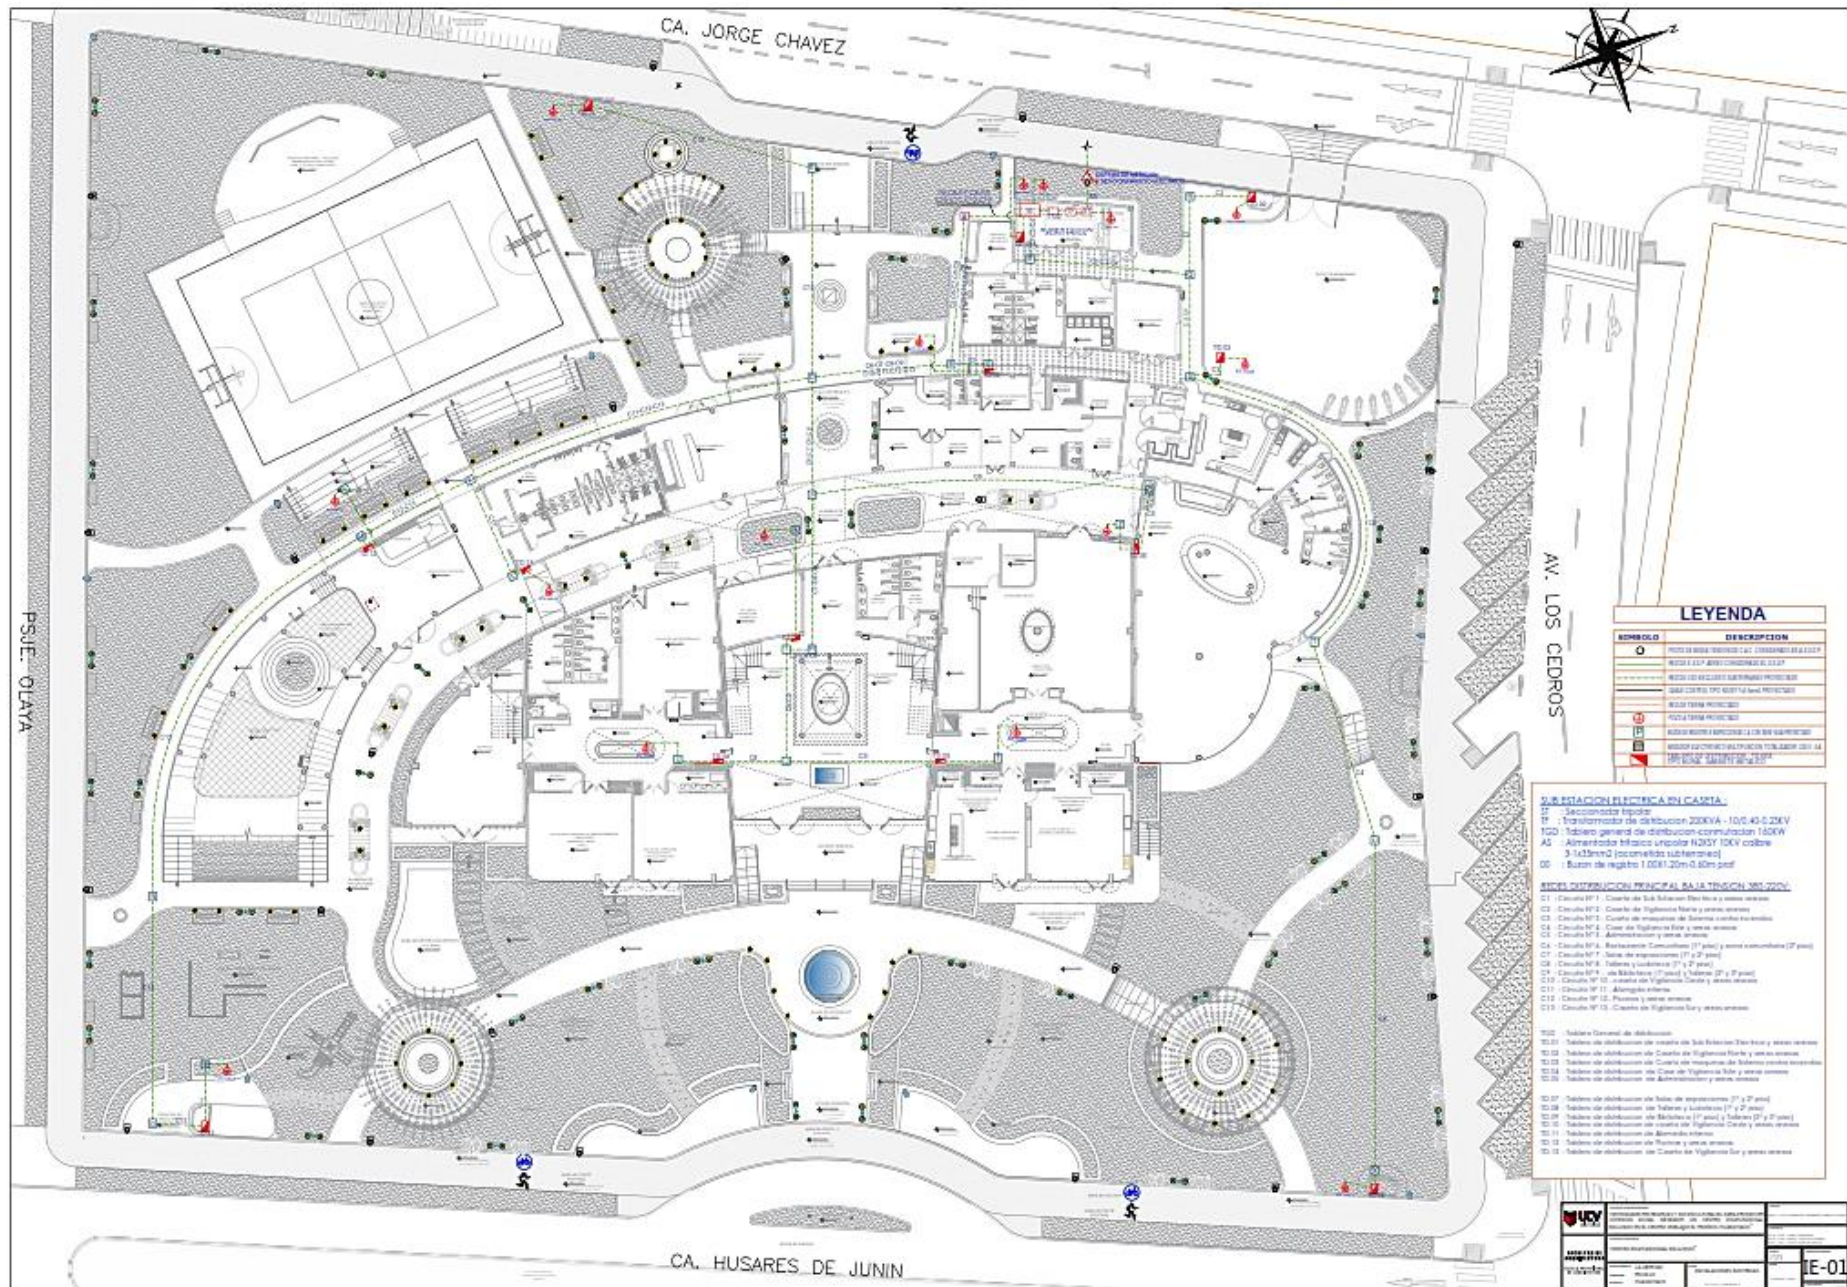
Red eléctrica. Planta general: IE-01. Fuente: Propia (2018)
